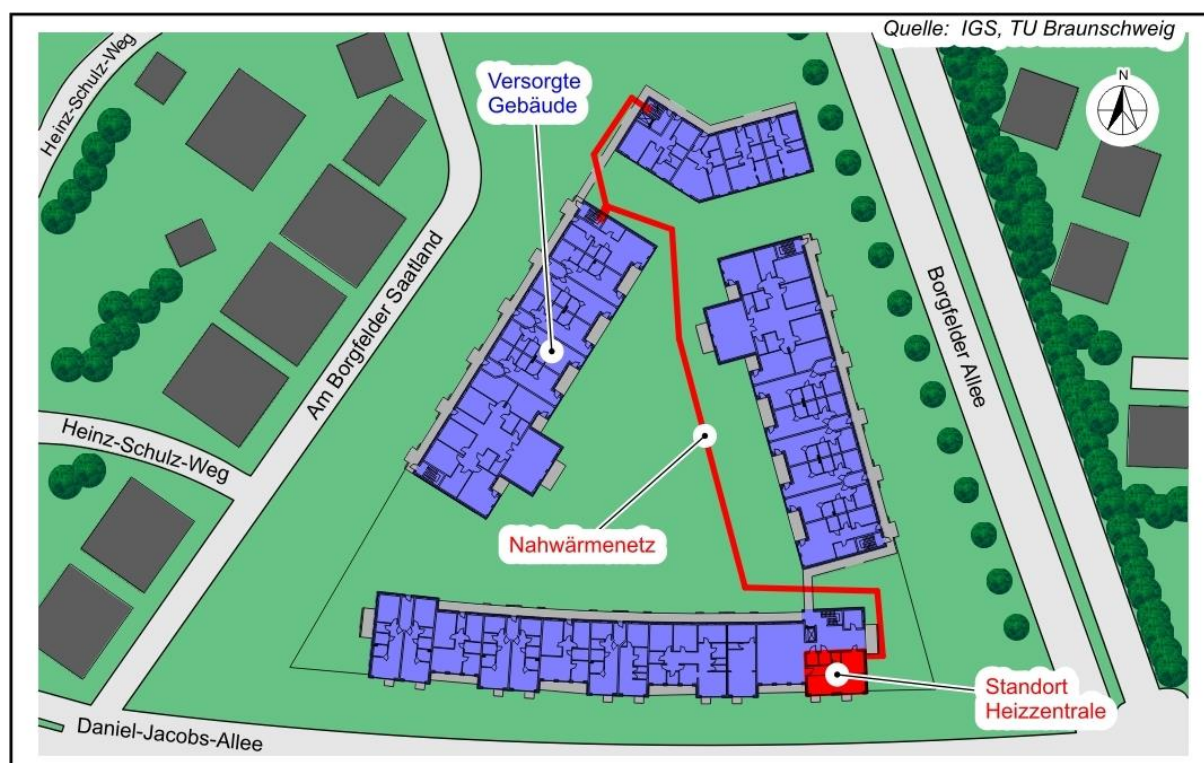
Lageplan Bremen, Stiftungsdorf Borgfeld
